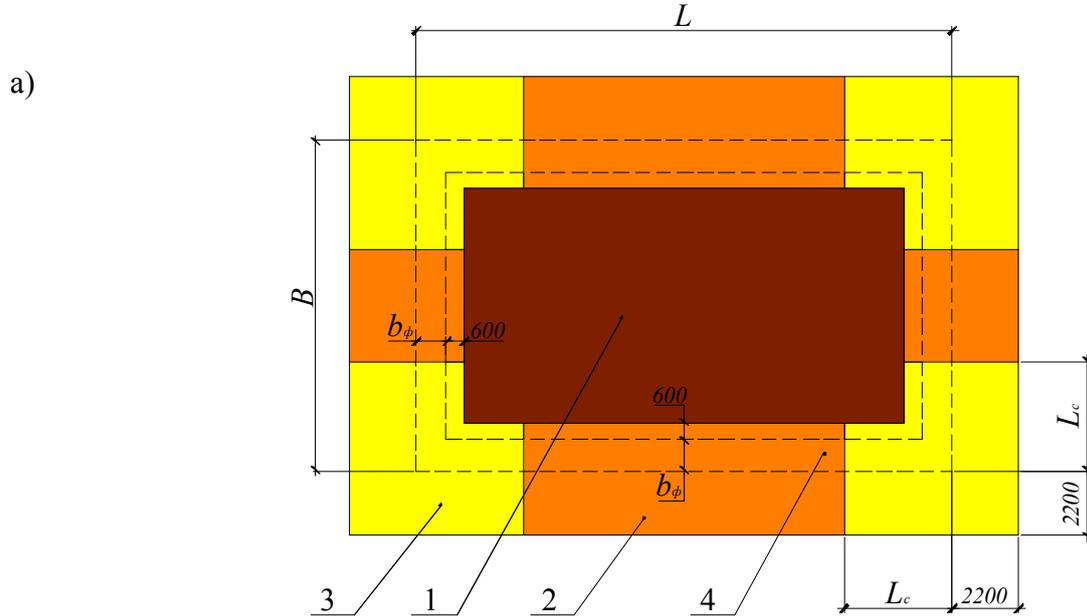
Схема к расчету параметров теплоизоляции из плит ПЕНОПЛЭКС®:
